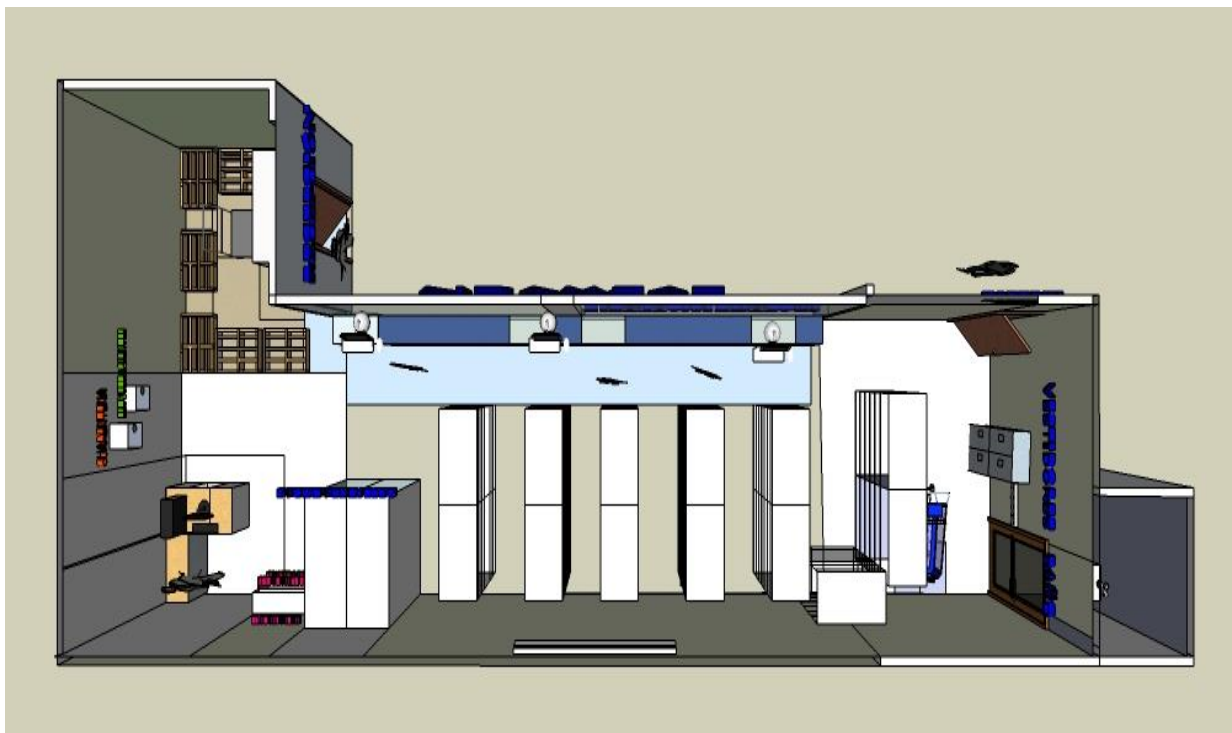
23 Vista en Planta del prototipo del área de farmacia
